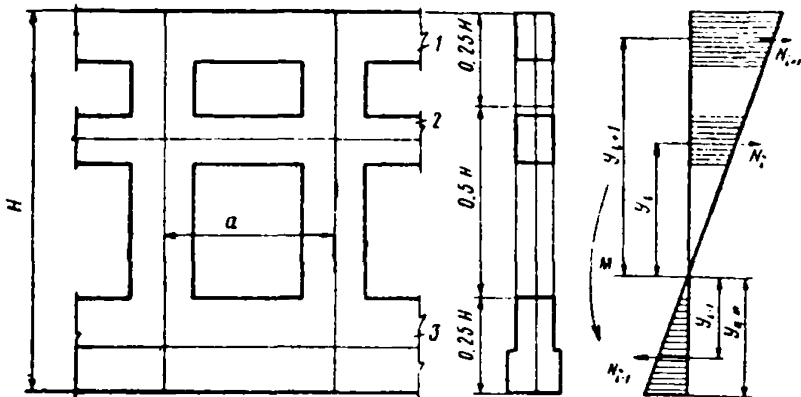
Фрагмент стены и эпюры нормальных сил в ее сечении
